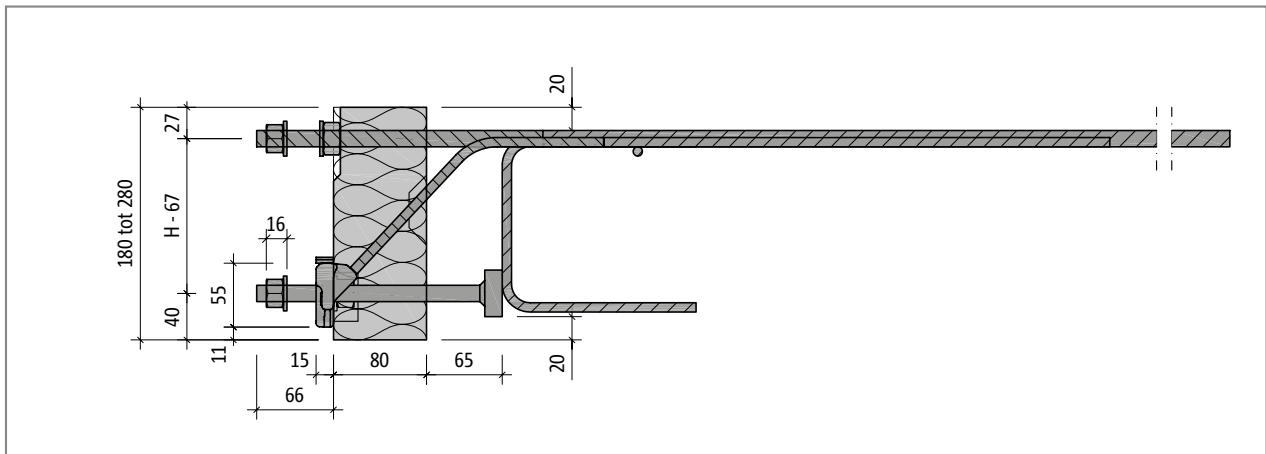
Schöck Isokorf® T type SK-MM2-VV1: Bovenaanzicht
